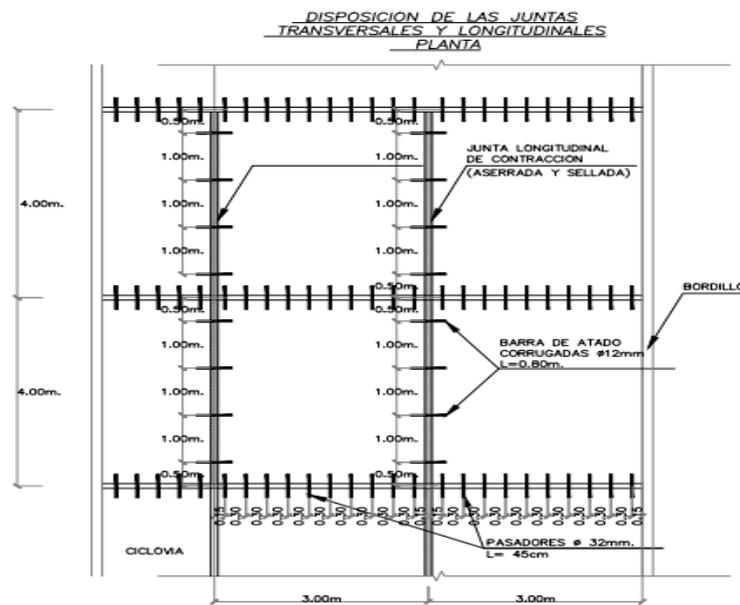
Disposición de las juntas transversales y longitudinales vista en planta
